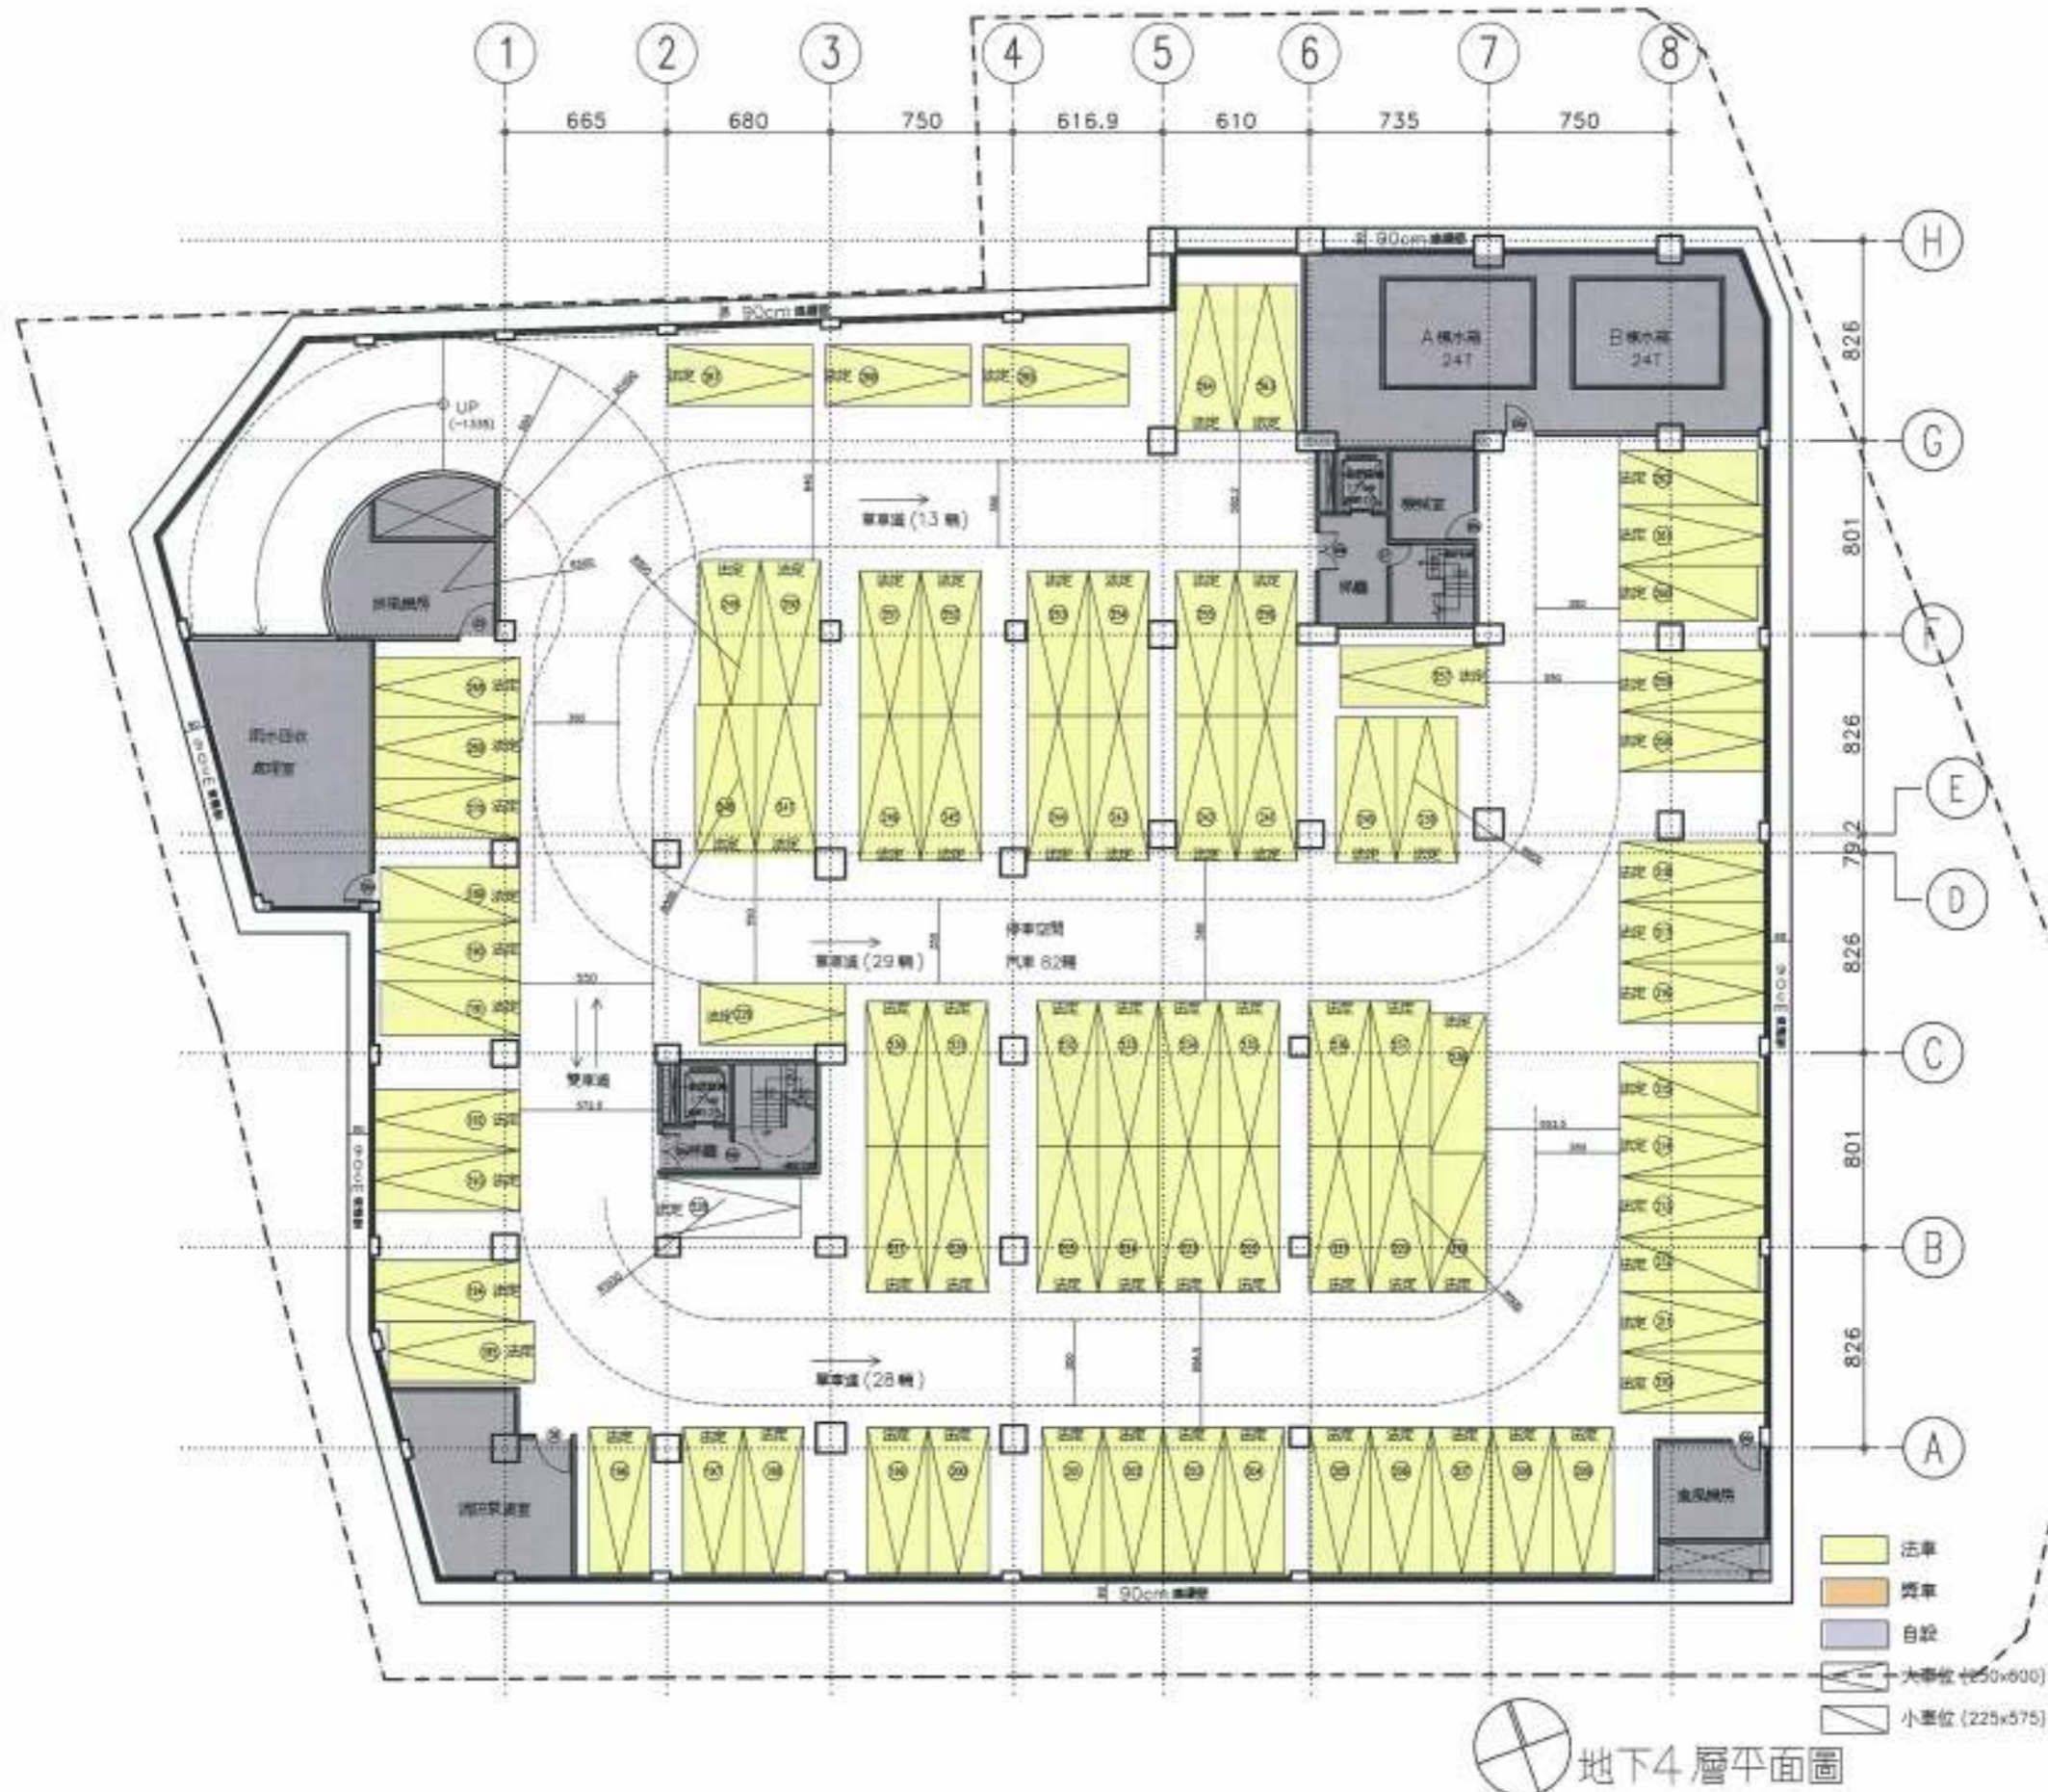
地下四層平面及面積計算圖(S : 1/300)
